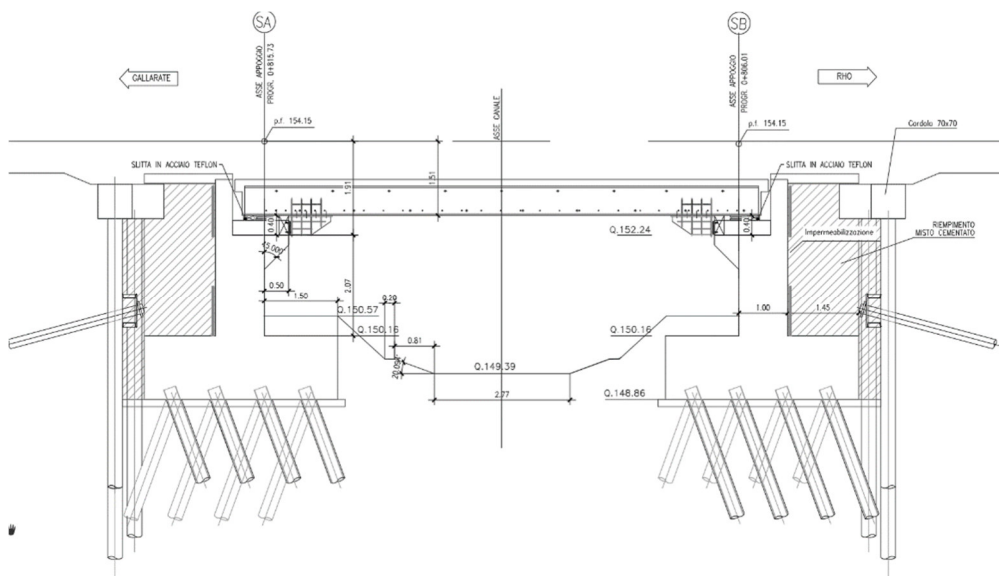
SEZIONE PONTE IN PROGETTO
